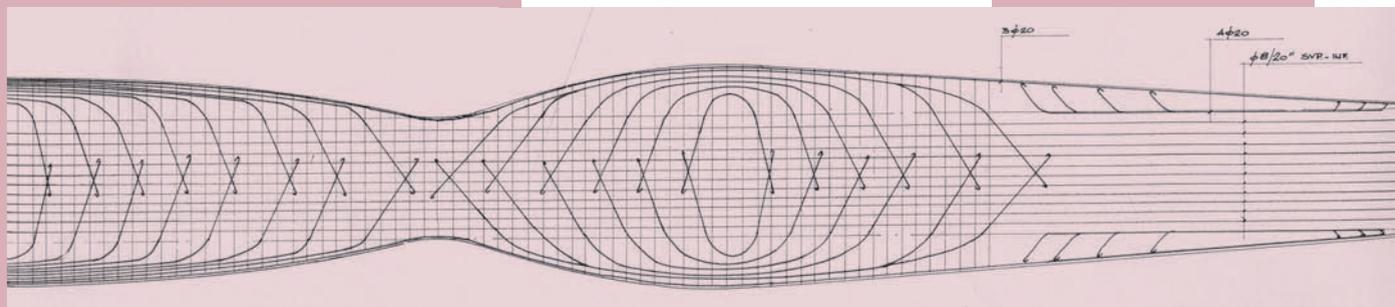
Vista dell'intradosso della campata centrale dell'impalcato
